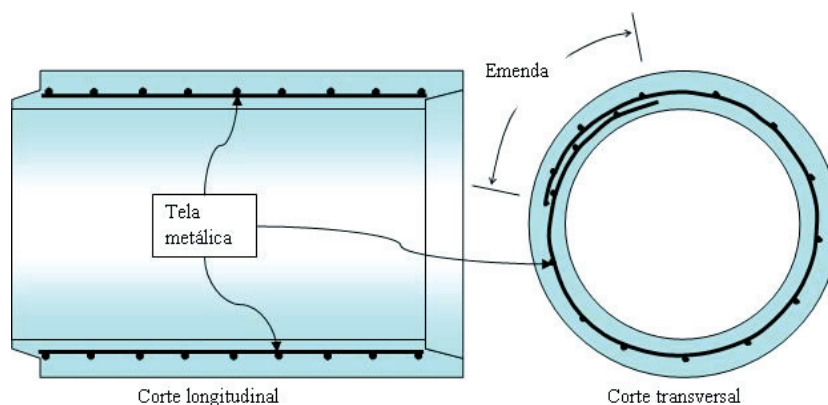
Posicionamento de armadura simples com tela soldada em um tubo macho e fêmea
